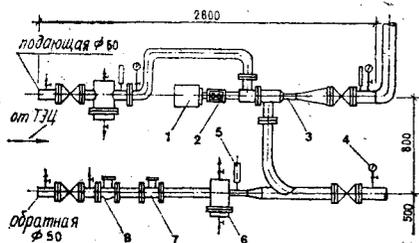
Электронный элеватор с регулируемым соплом типа «Электроника Р-1»: 1 — синхронный электродвигатель; 2 — трехступенчатый цилиндрический редуктор; 3 — элеватор; 4 — манометр; 5 — термометр; 6 — грязевик; 7 — водомер; 8 — реле давления.
